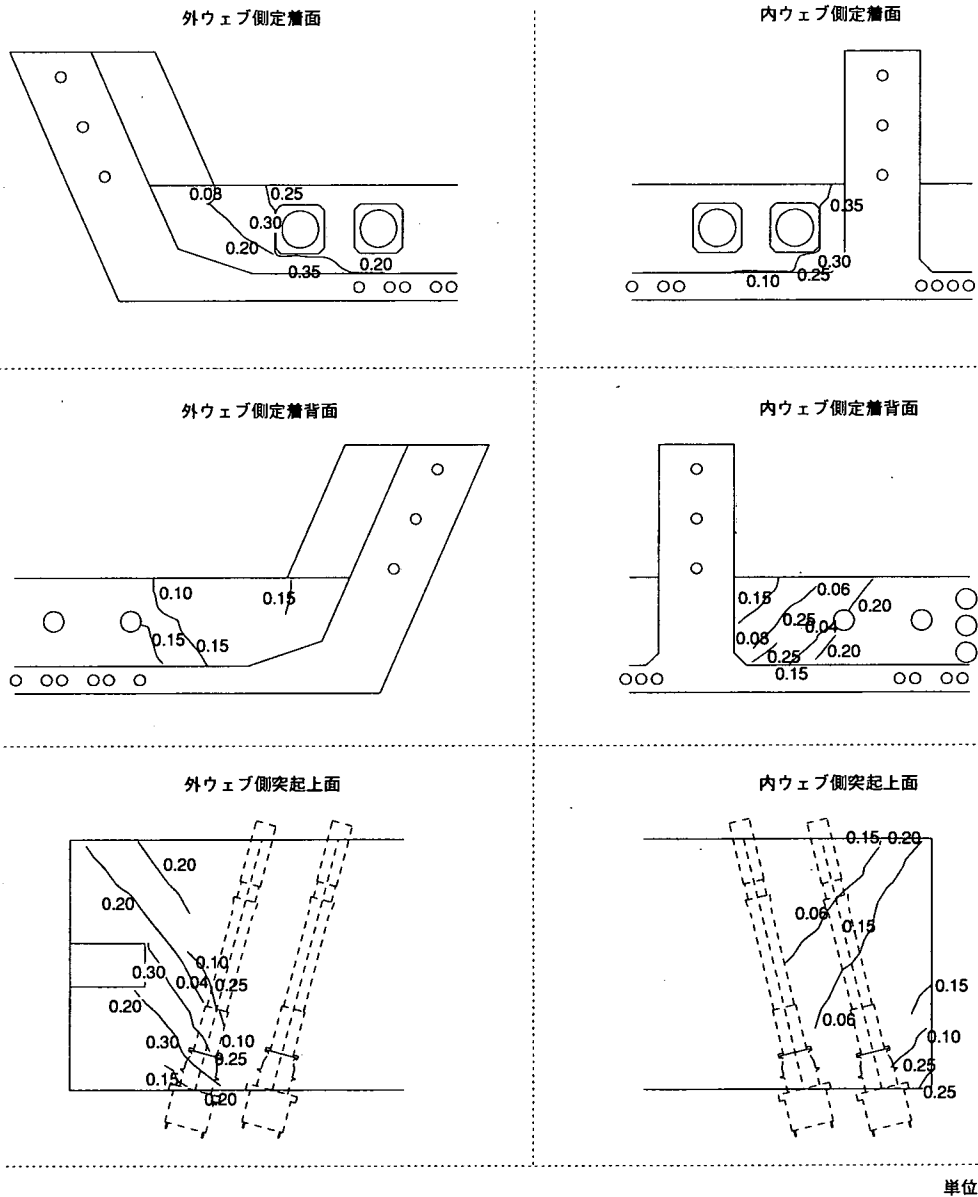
揖斐川橋外ケーブル定着部試験 ひび割れ発生状況 (ケース 1)
